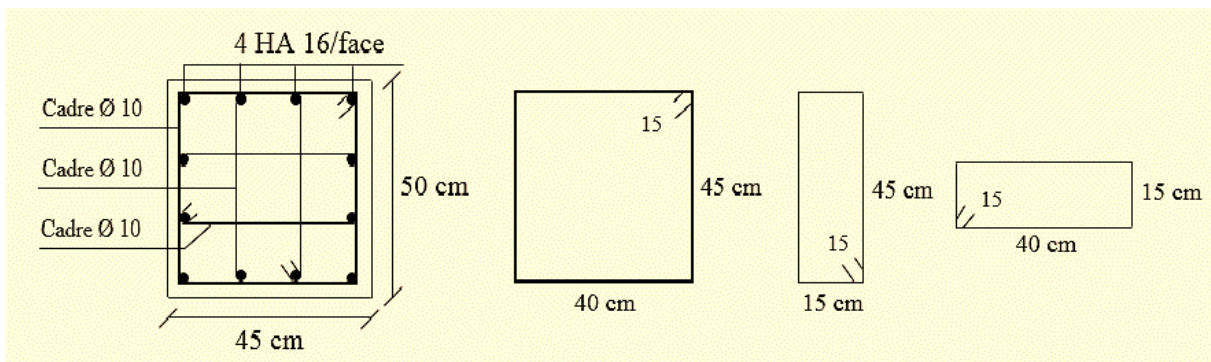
Coupe de ferrailage des poteaux 45×50 cm²
